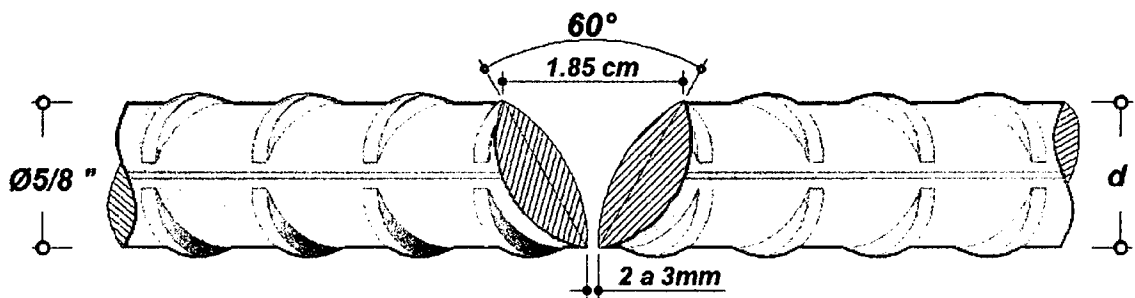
Detalle de corte en miembros de probeta para soldadura a tope directo con borde en "V" en barra de $\varnothing 5/8''$
